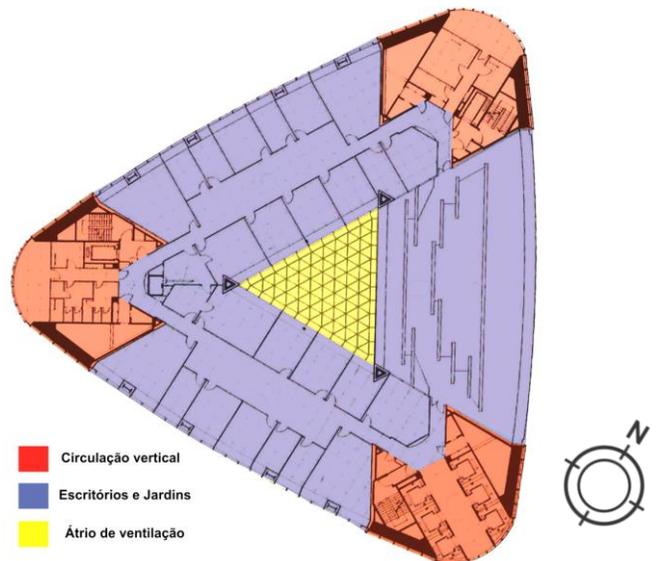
Planta de Pavimento Tipo - Disposição das principais funções do edifício.
